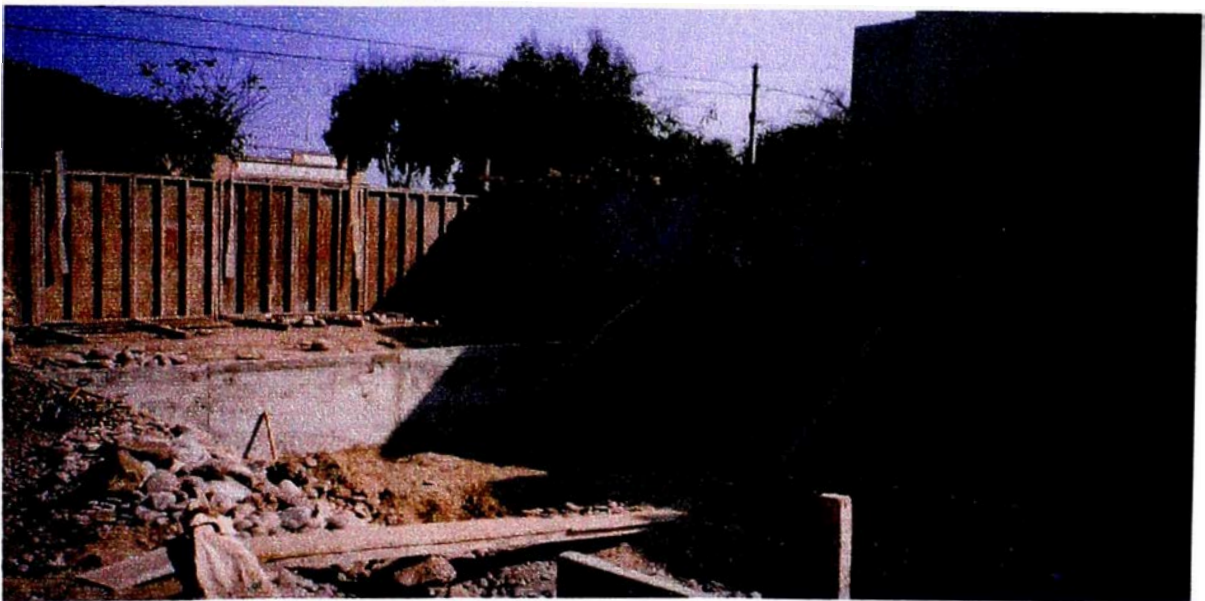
Calzadura del borde de la losa de cimentación y apuntalado de paredes adyacentes
